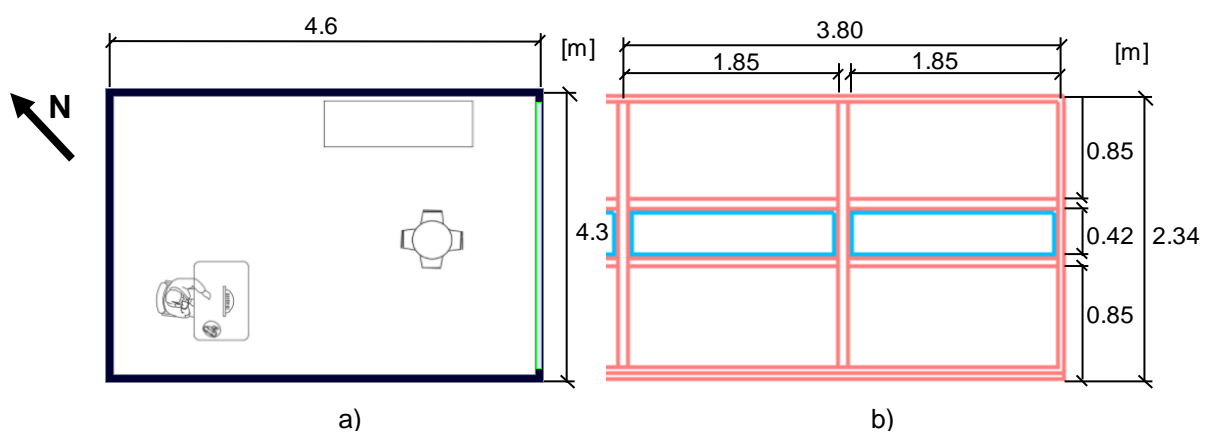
Gabinete de referência: a) planta esquemática; b) dimensões da área envidraçada (m).
